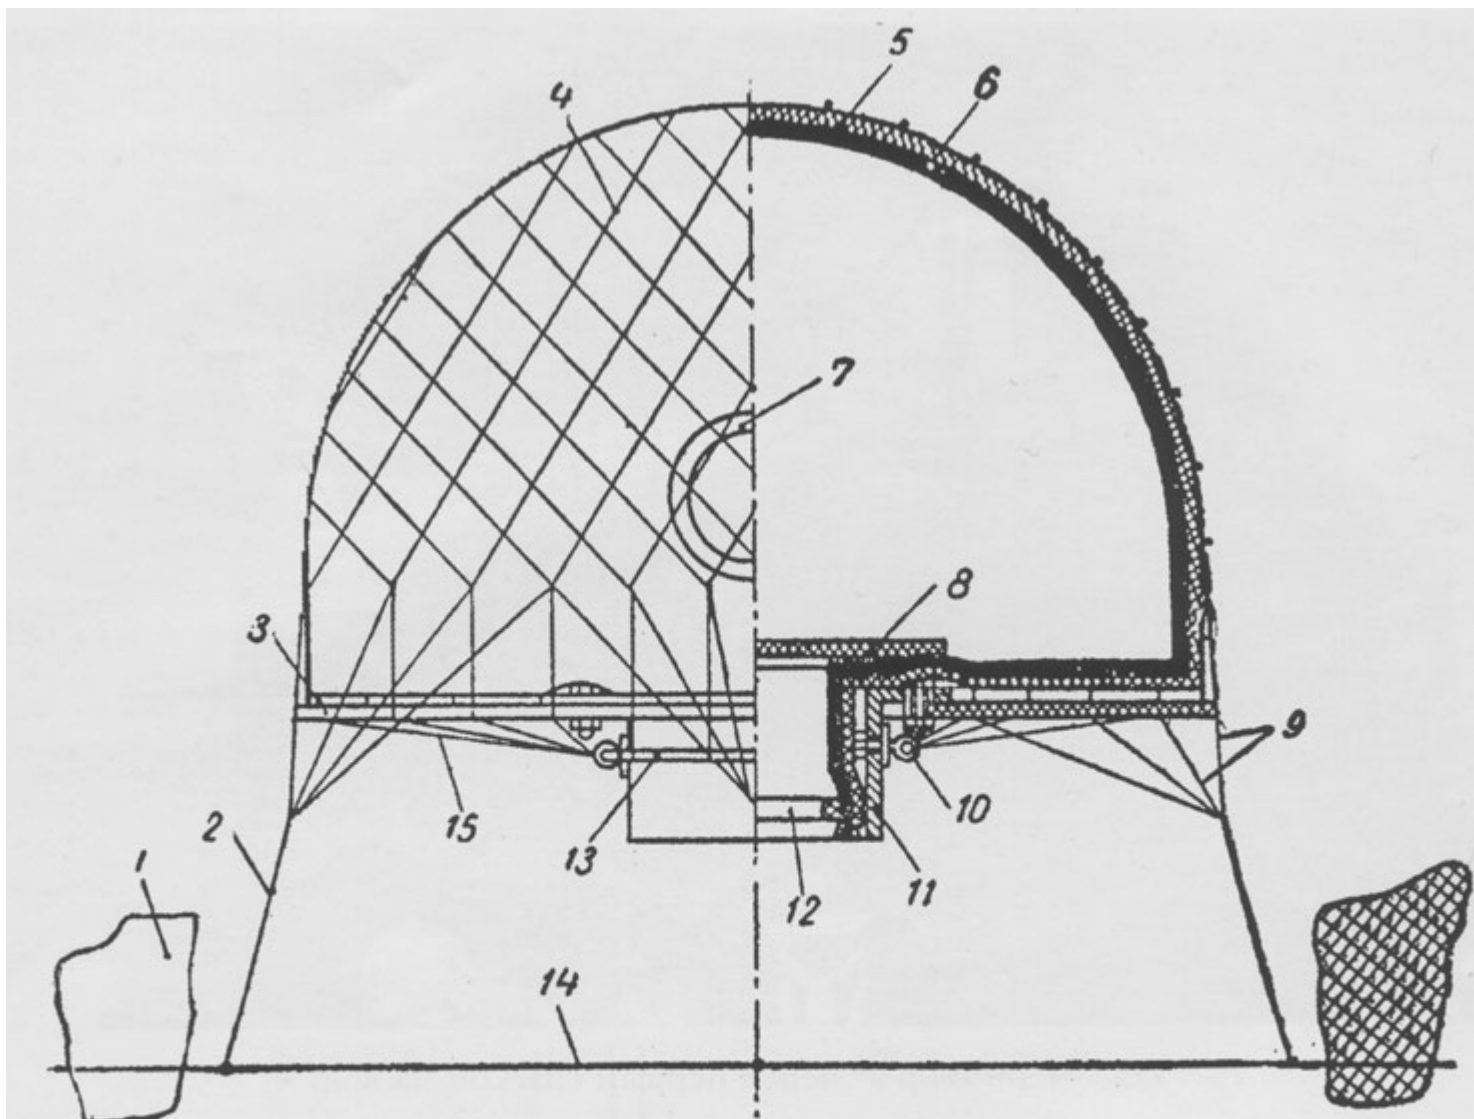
Первый "Спрут" в разрезе: 1 — камень; 2 — стропа; 3 — пол; 4 — сеть; 5 — теплоизолирующая оболочка; 6 — газонепроницаемая оболочка; 7 — иллюминатор; 8 — крышка люка; 9 — спуски крепления дома; 10 — рым; 11 — люк; 12 — распорное кольцо; 13 — тросовое кольцо подвески пола; 14 — трос; 15 — спуски подвески пола.
